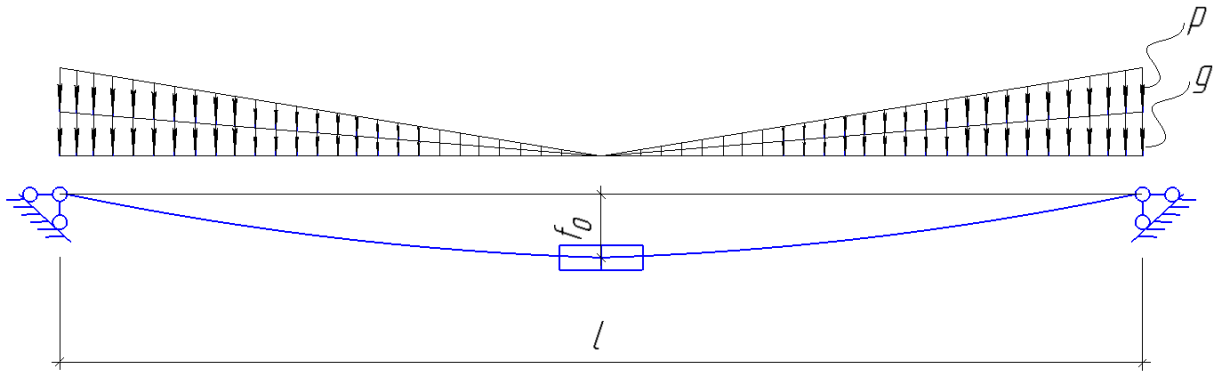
Расчетная схема покрытия круглого плана с центральным кольцом, нити расположены радиально
